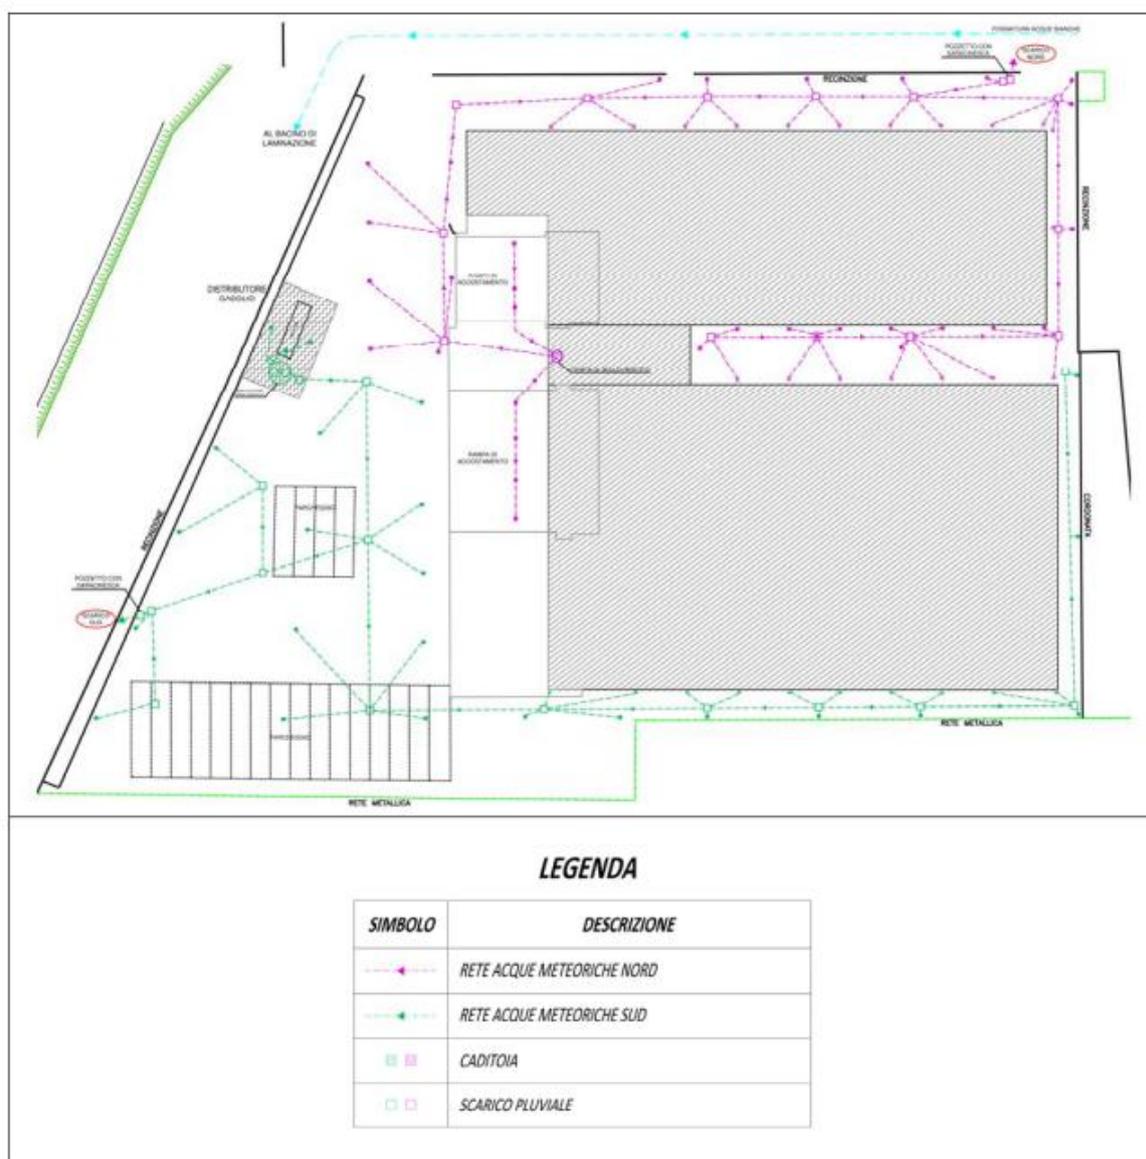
Planimetria della rete di scarico- stato di fatto
